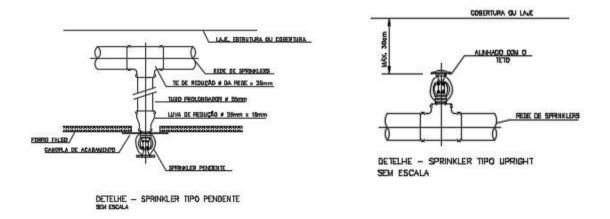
Detalhes genéricos sprinkler tipo pendente e upright
